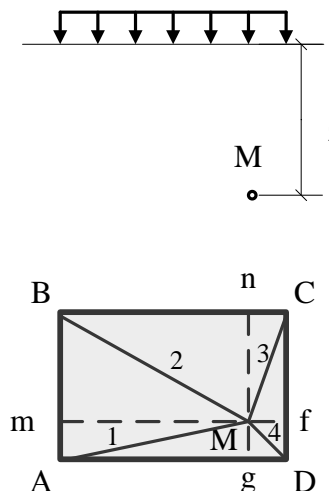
Схема к определению напряжений по методу угловых точек.
